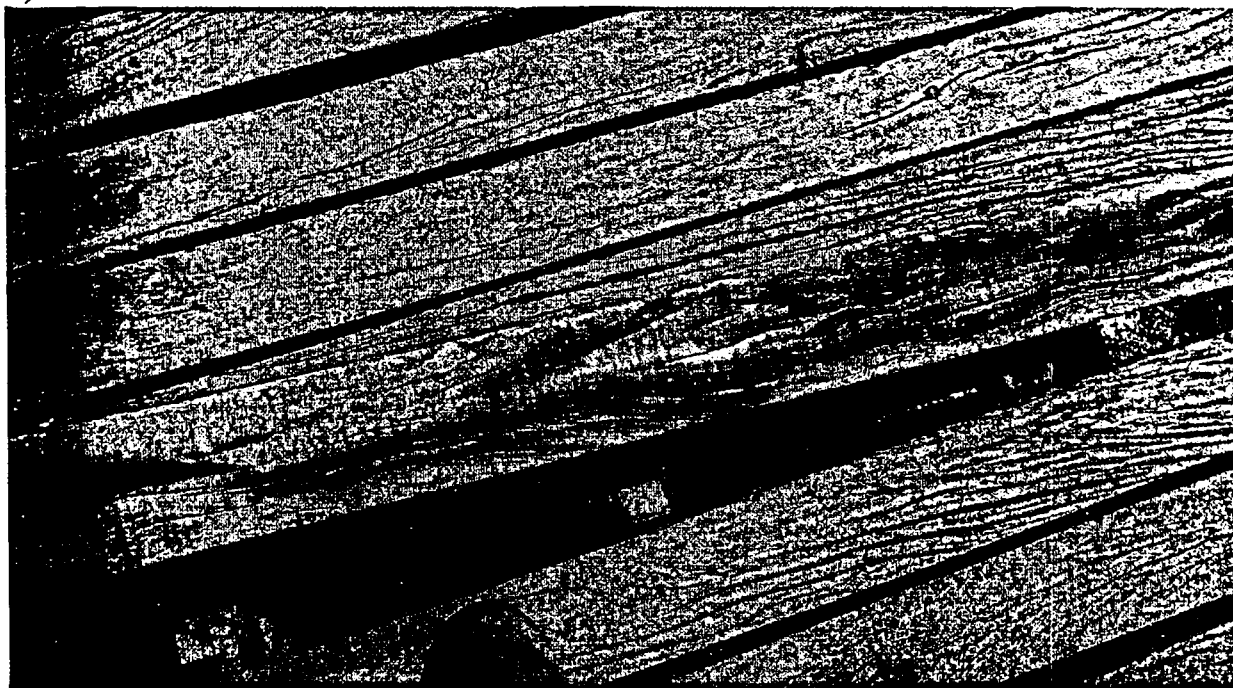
Vista de pranchão do piso a ser substituído e vigas de sustentação do piso.
